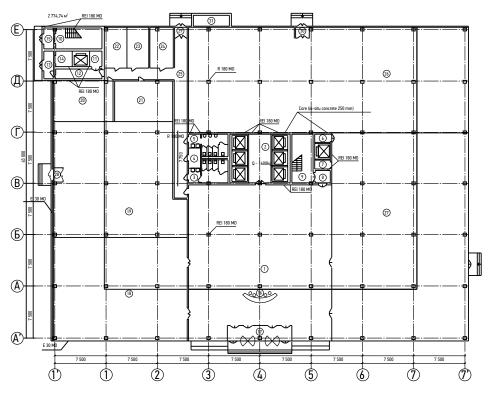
План нижнего этажа при короткопролетной схеме каркаса здания. Внутренние колонны по осям Б, В, Г и Д отсутствуют на длиннопролетной схеме (за исключением колонн на осях 1 и 7)
